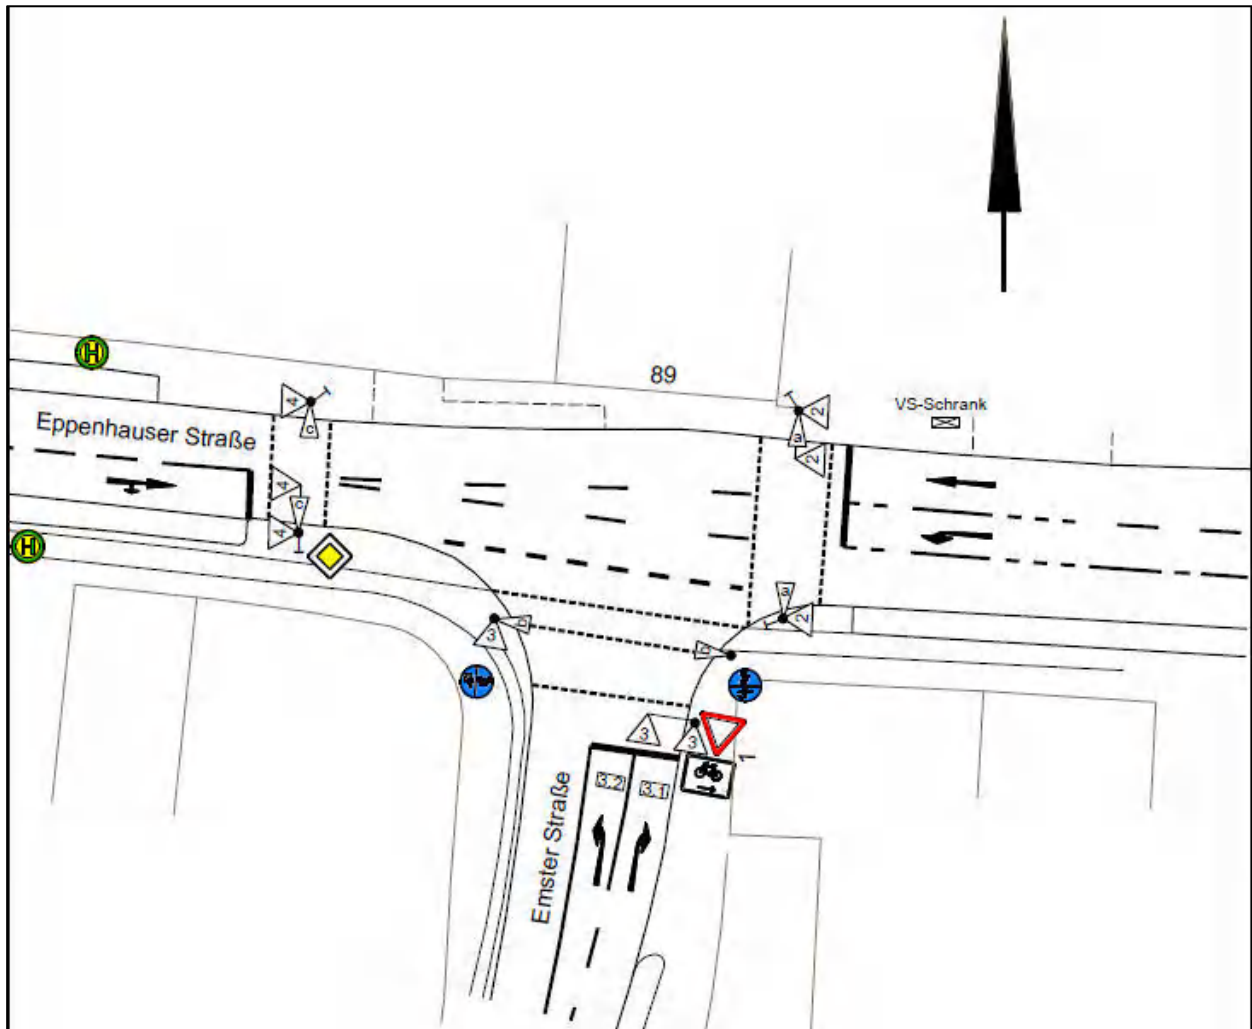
Signallageplan des Knotenpunktes Eppenhauser Str/ Emster Str.
